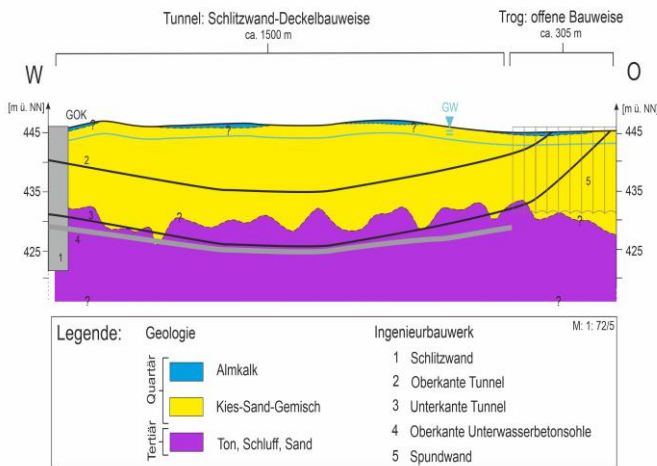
Schematisches Untergrundprofil des Bauvorhabens mit bautechnischer Umsetzung des Tunnels.
